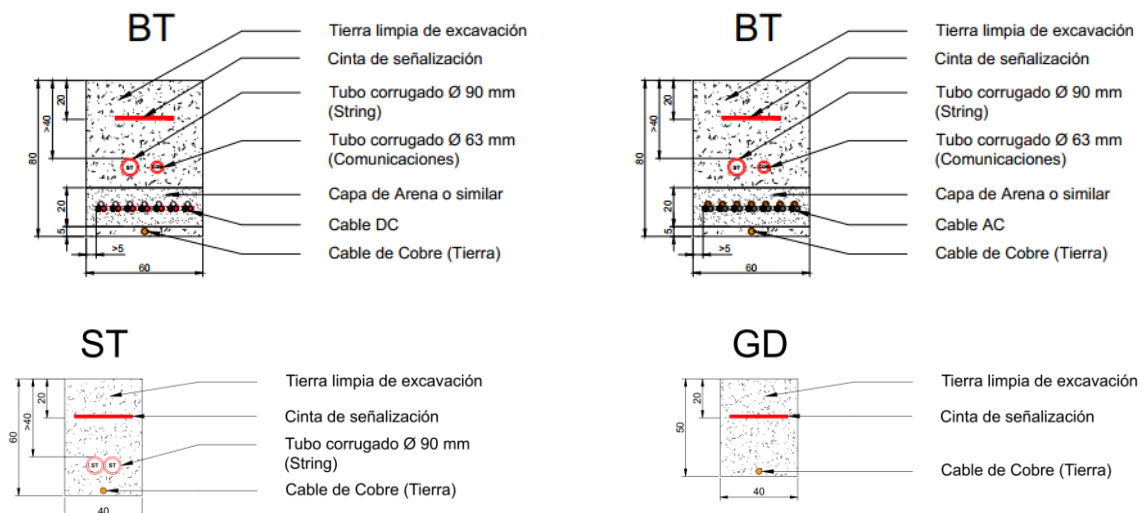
Sección tipo zona de paso – acceso a C.T.
